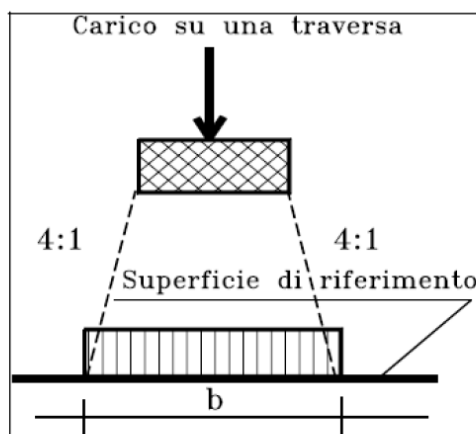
Distribuzione longitudinale dei carichi attraverso il ballast
